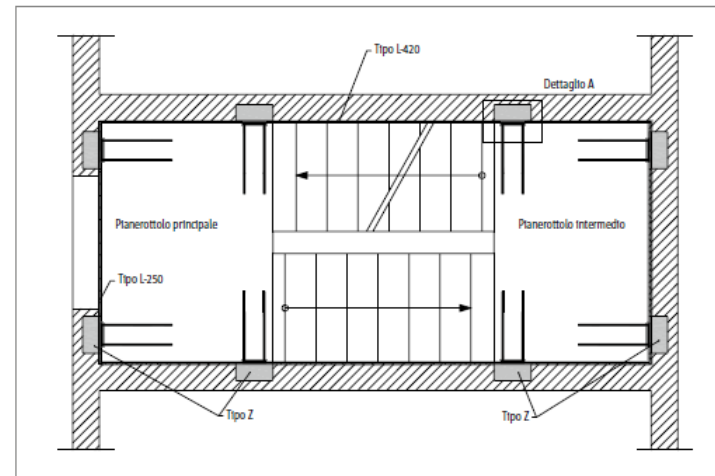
Schöck Tronsole® tipo Z, disposizione alternativa dell'elemento nella pianta
